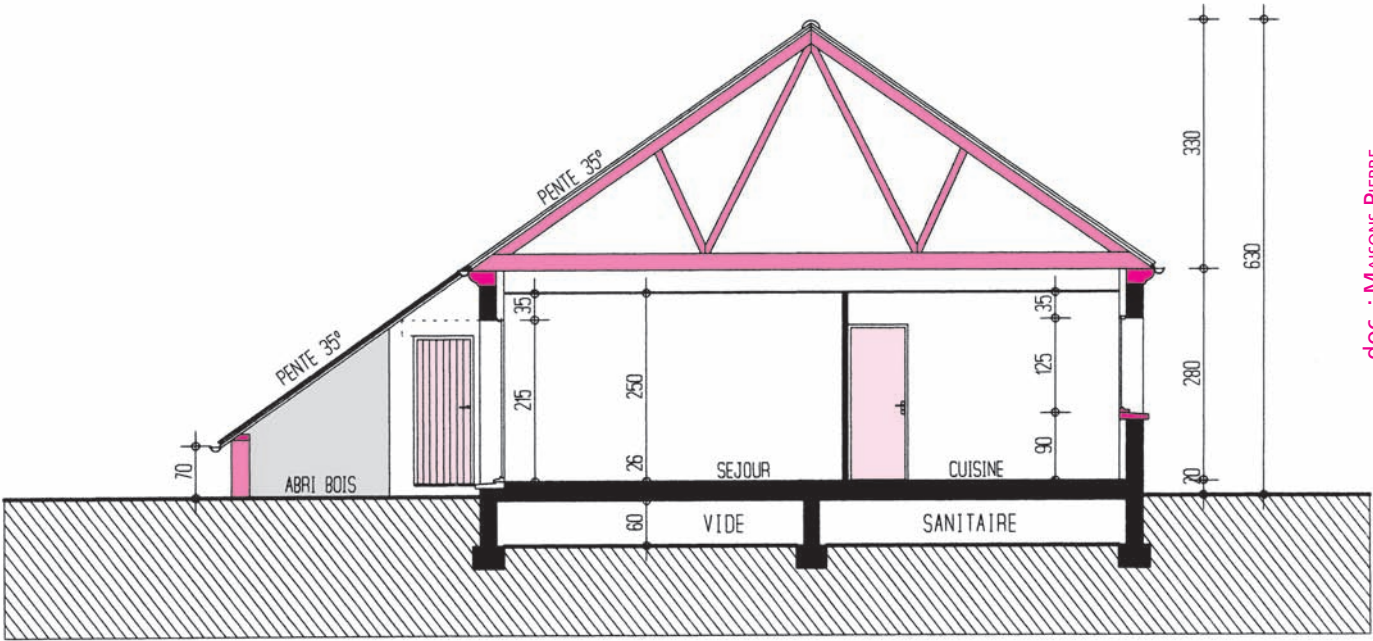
Coupe verticale (fondations par semelle, soubassement maçonné et plancher sur VS)
